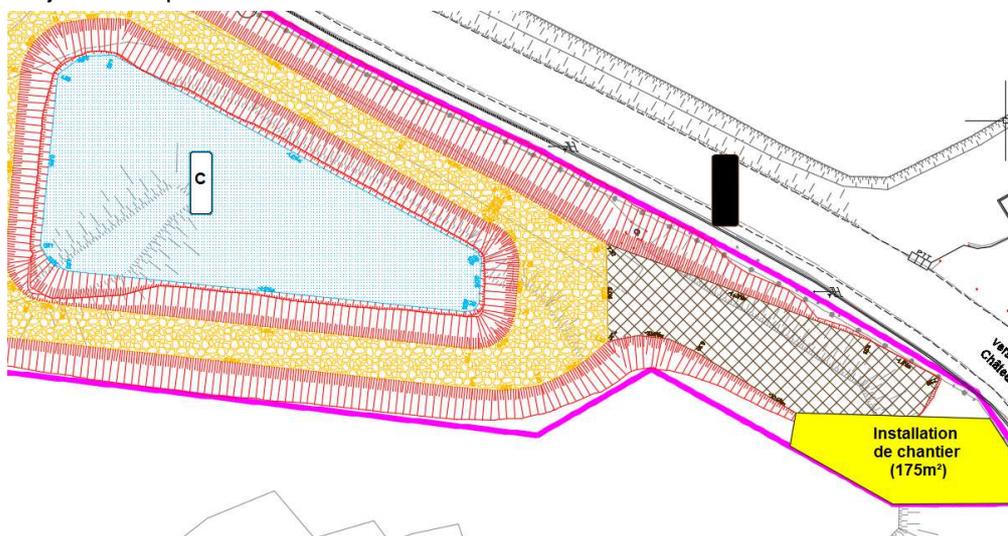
Extrait du plan avec localisation des installations de chantier (source : SAFEGE 2018)
